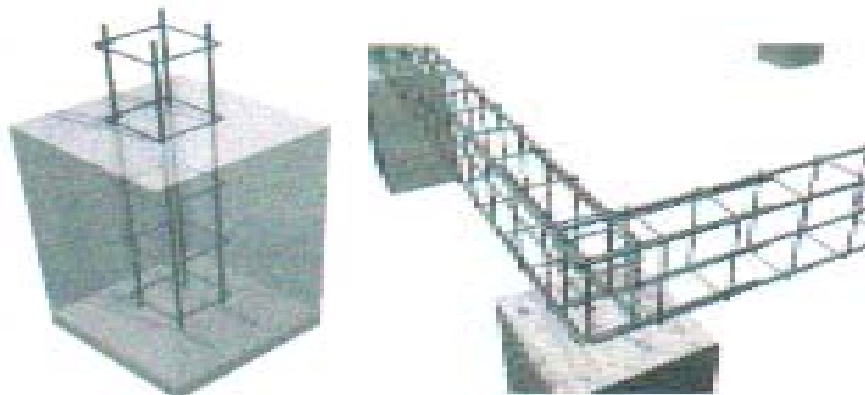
Cimentación de pilas cuadradas de concreto y sobre de ellas el armado de las dalas.
